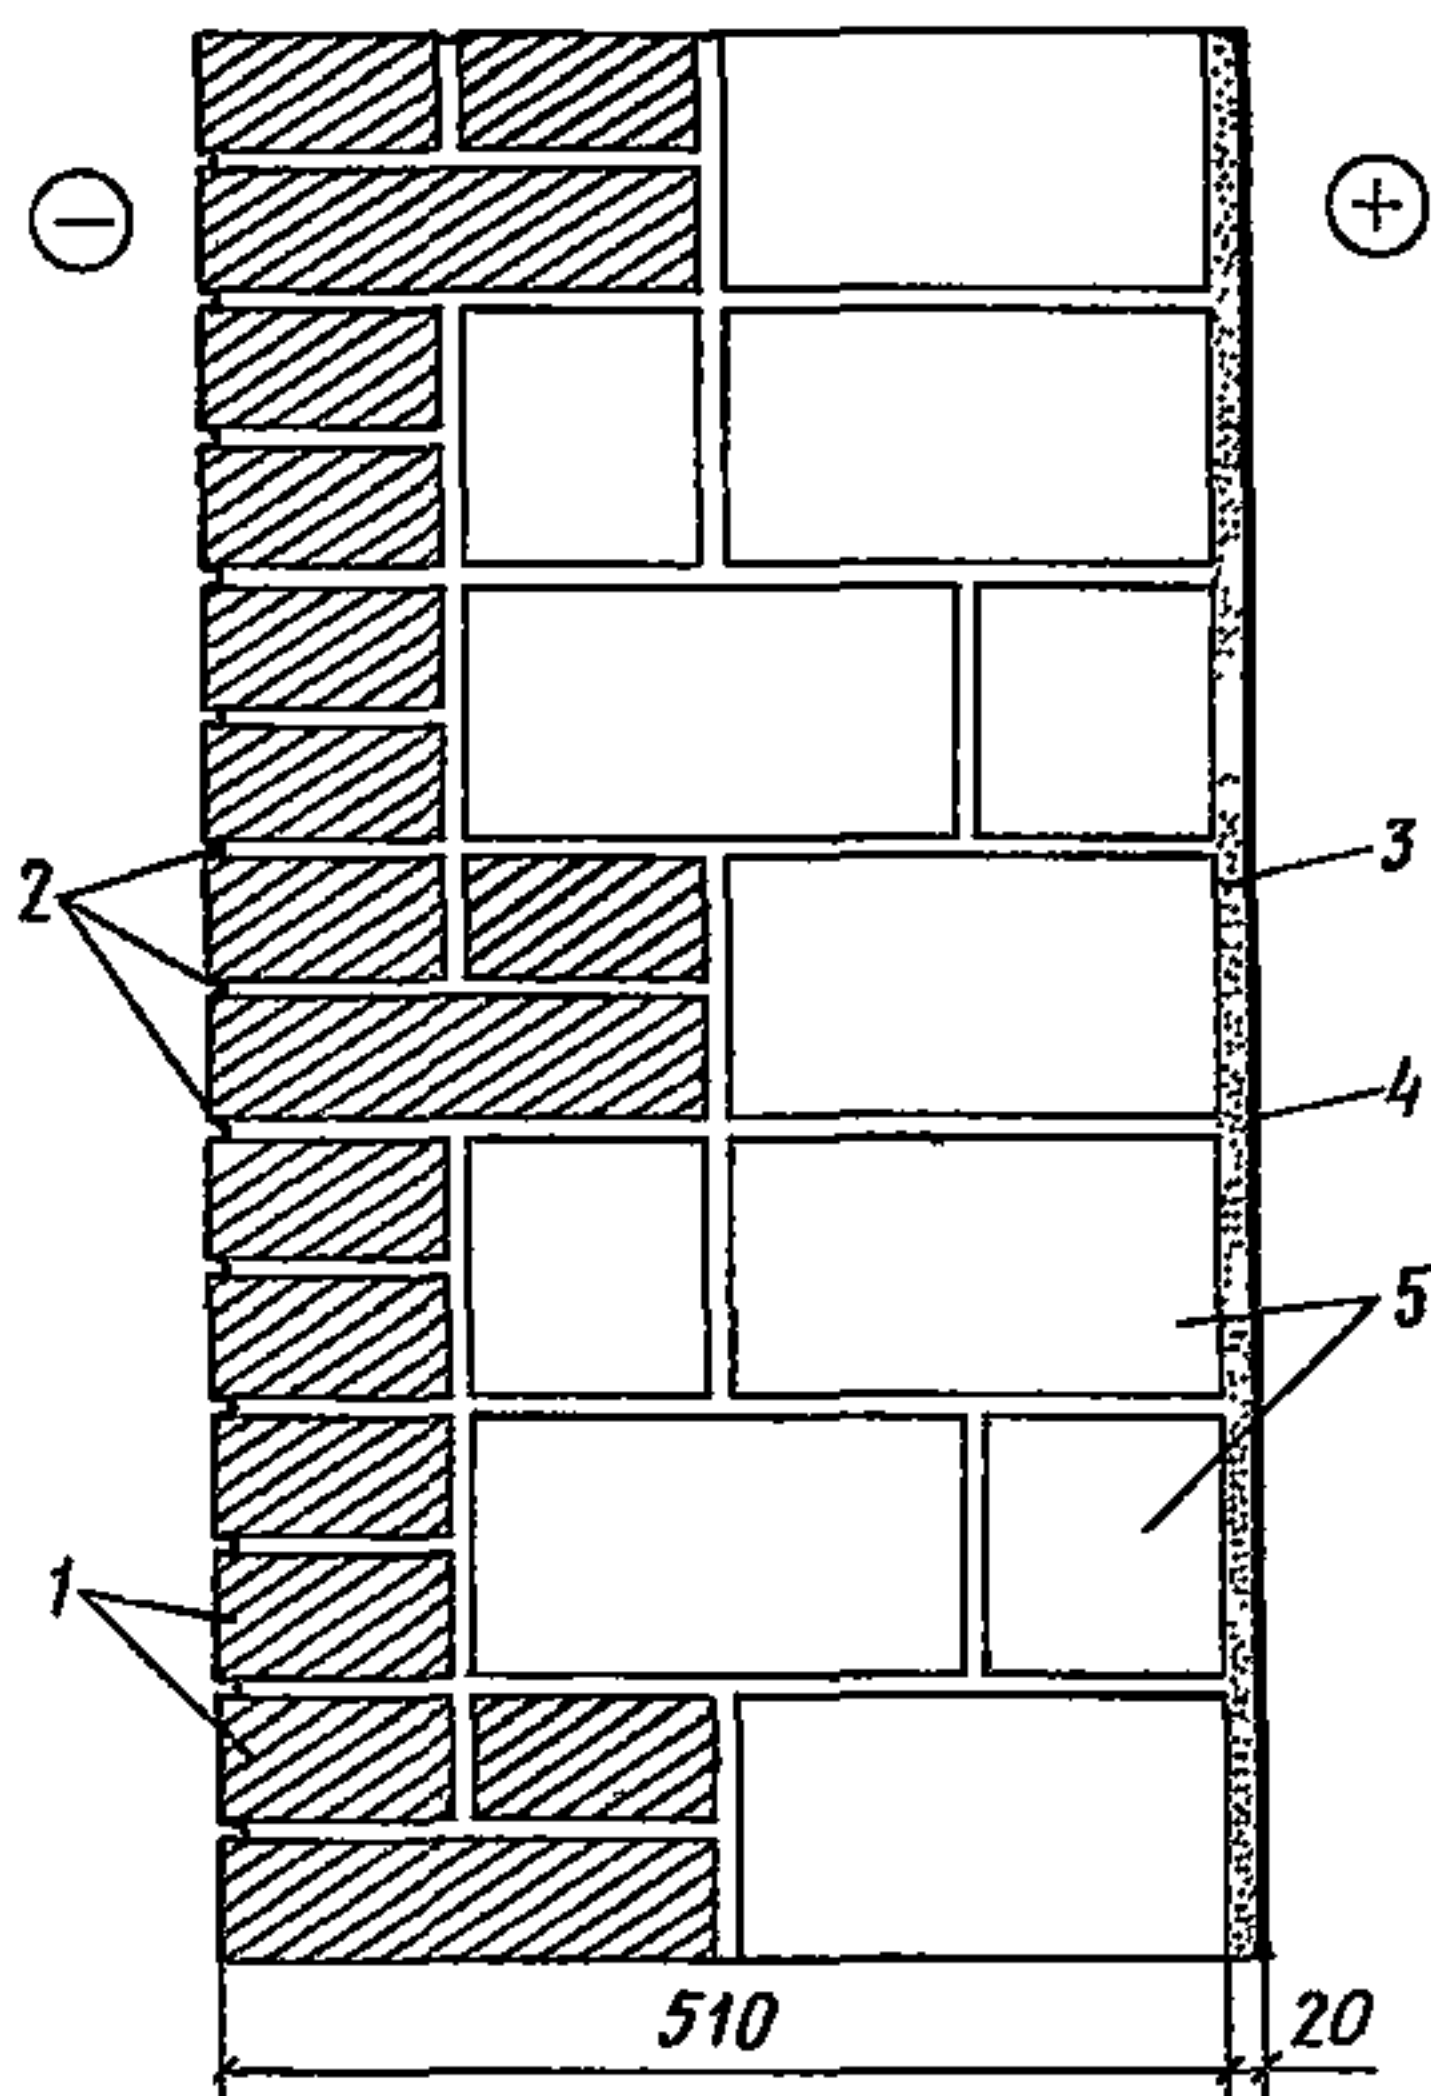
Конструкция наружной стены здания сушки калийного комбината:
